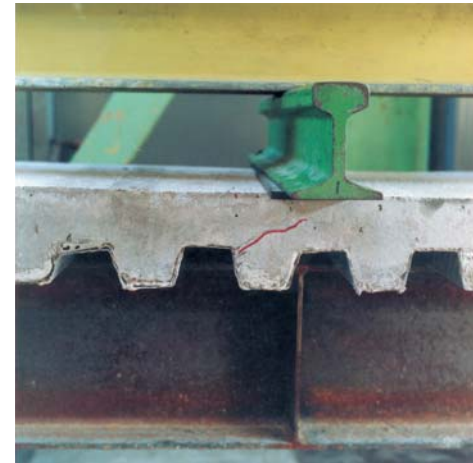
Échantillon t2 après l'affaissement de la poutre en acier : détail sur le milieu 34
